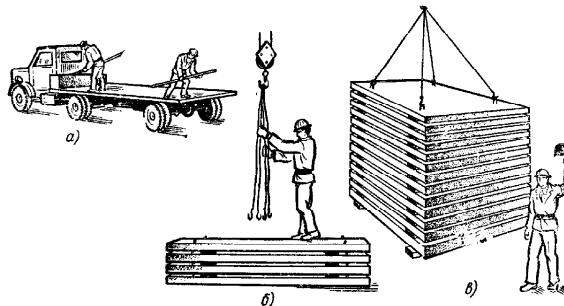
Погрузка плит перекрытия на автотранспорт:
